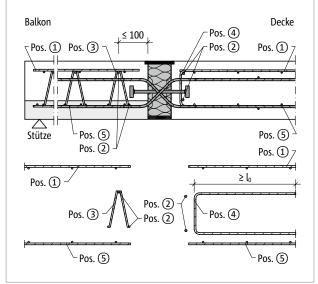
Schöck Isokorb® T Typ QP: Bauseitige Bewehrung, balkonseitig mit Gitterträger
